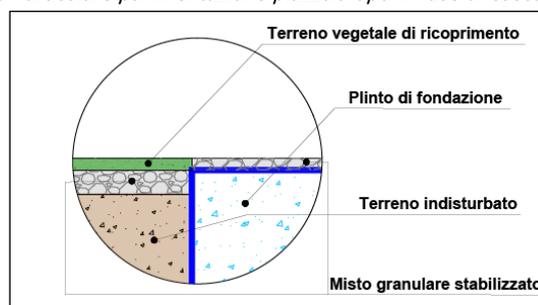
Particolare pavimentazione piazzola tipo in fase di esercizio
